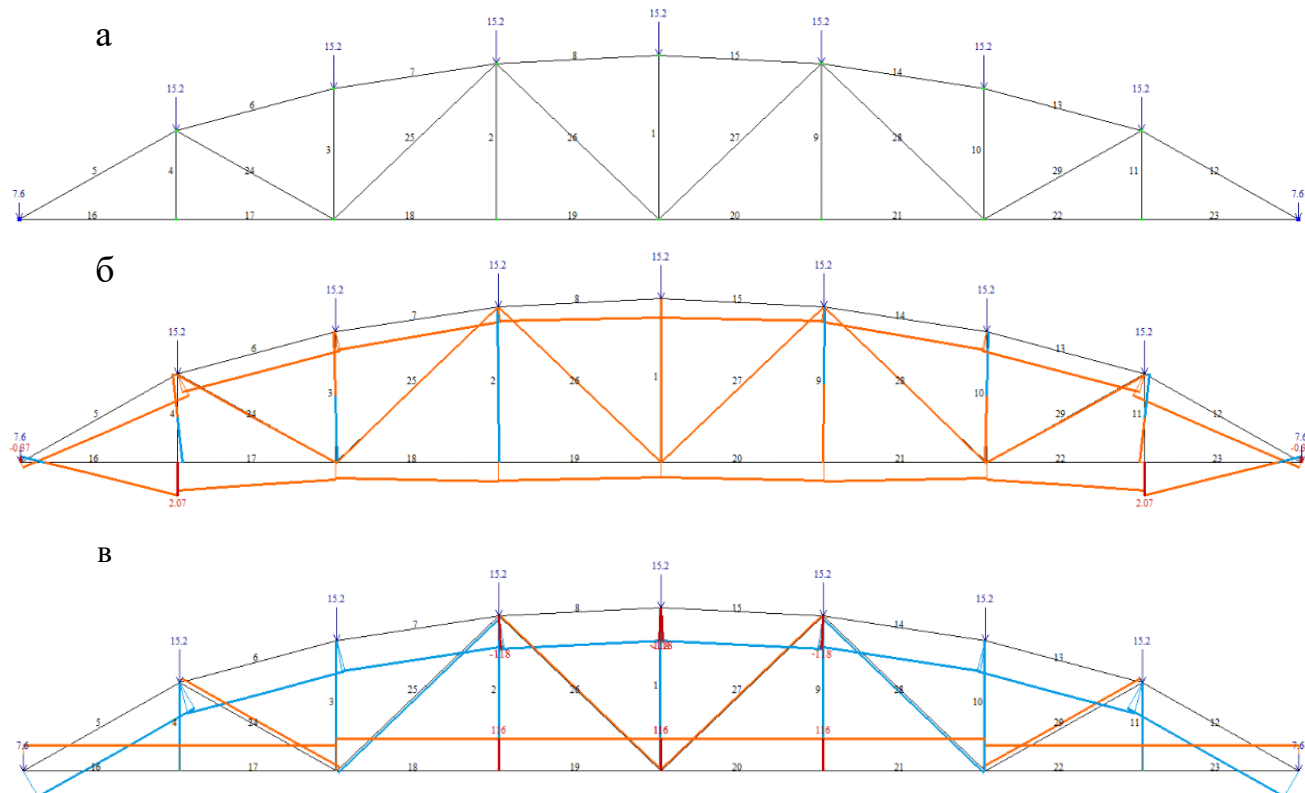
а) Розрахункова схема навантаження; б) Епюри згинальних моментів M_u ; в) Епюри повздовжніх сил N від навантаження покрівлі.
